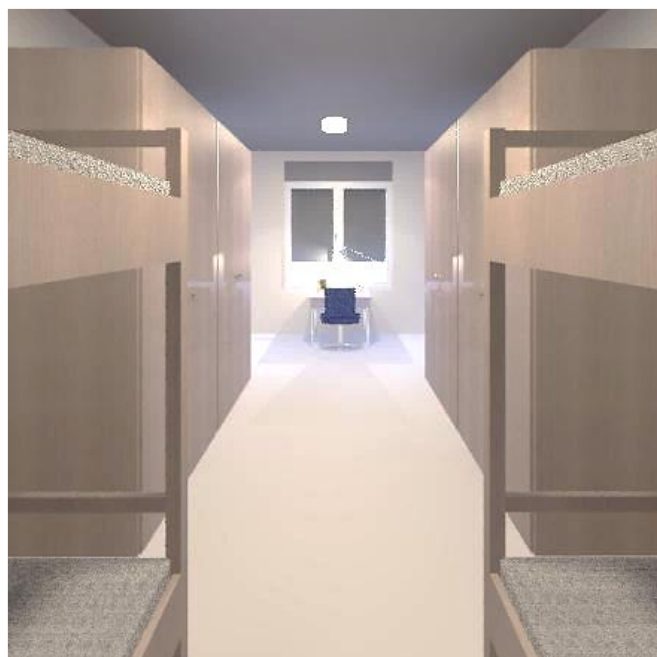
Perspectiva 1 – dormitorio. Fuente: elaboración propia con Revit.
